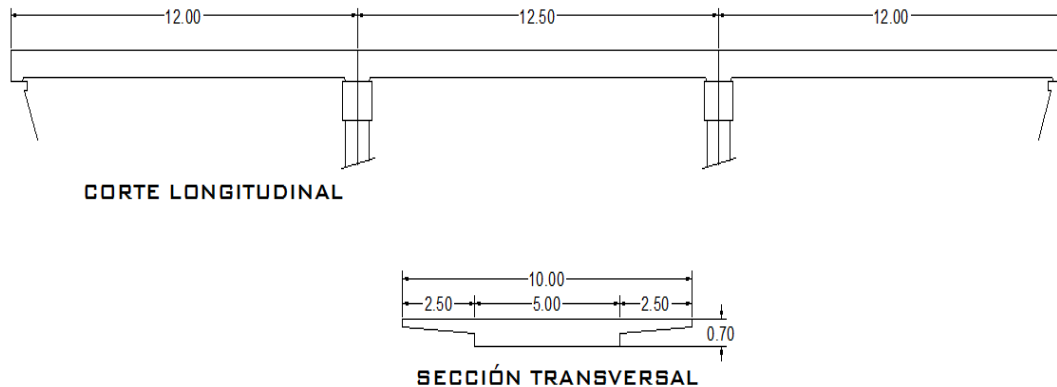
Geometría superestructura puente “Testarazo” (Acot. m).
